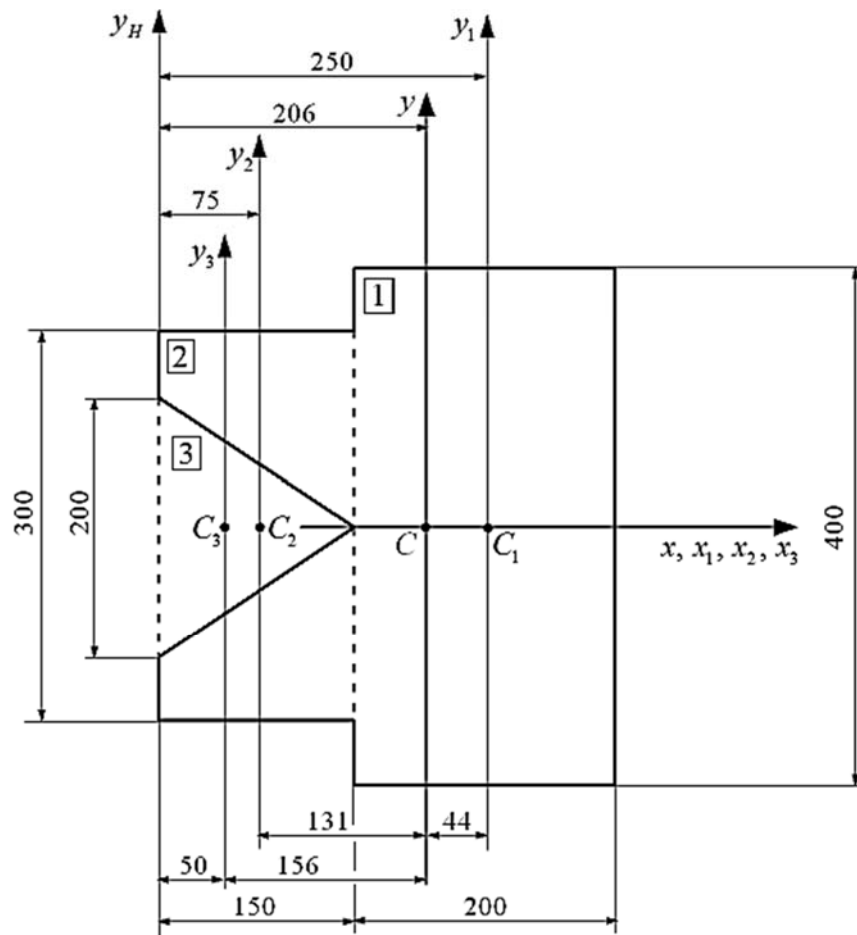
Разбиение поперечного сечения колонны на отдельные фигуры
